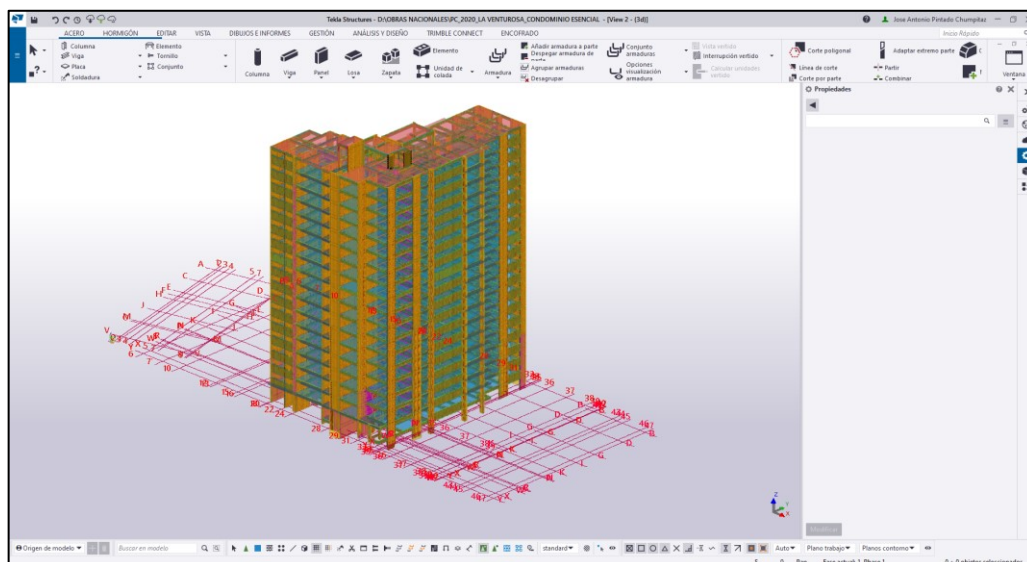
Modelado y detallado de concreto y armadura en Tekla Structures 2020 del proyecto Esencial Torre B Fuente: Elaboración propia
